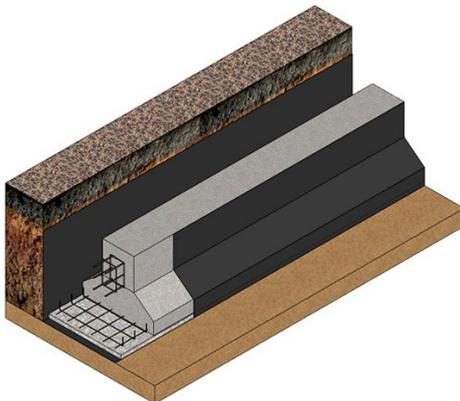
detalle de zapata corrida. www.xcons.com.ar
